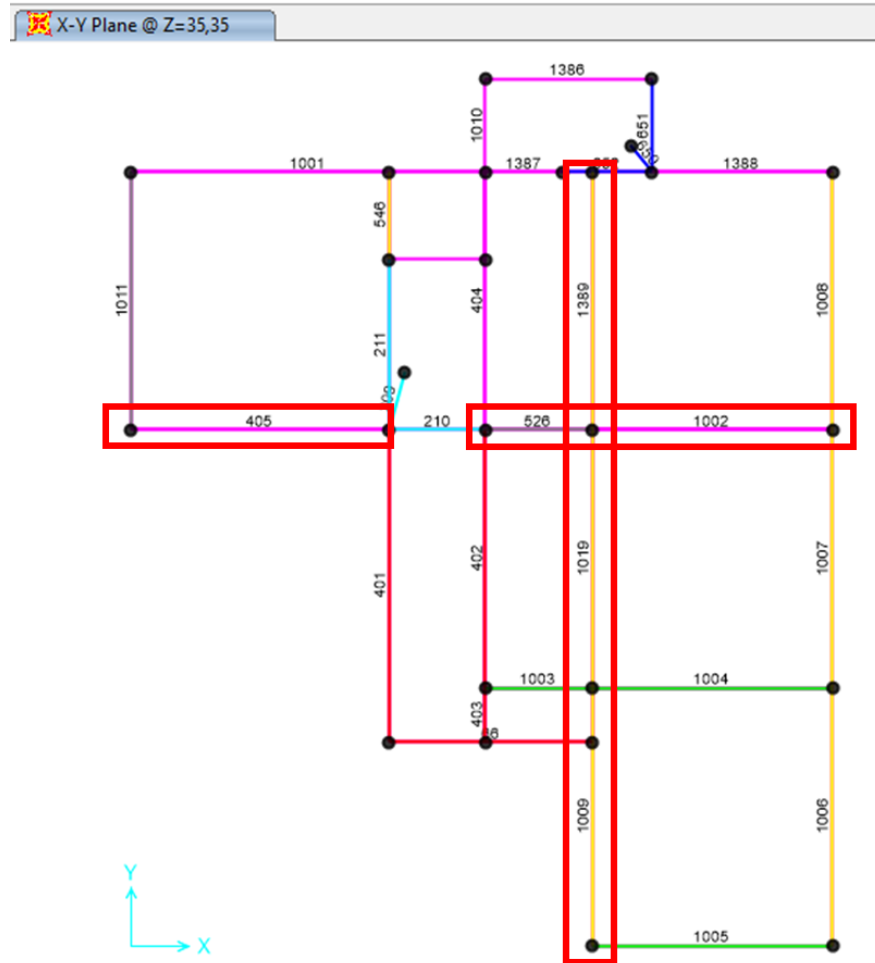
Definición de vigas modeladas para nivel Z=35,35 y vigas seleccionadas
